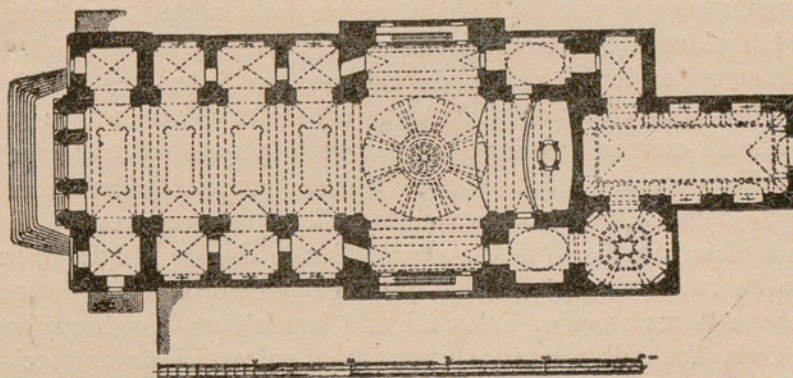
Planta de San Juan Bautista, de Toledo. (O. Schubert.)
